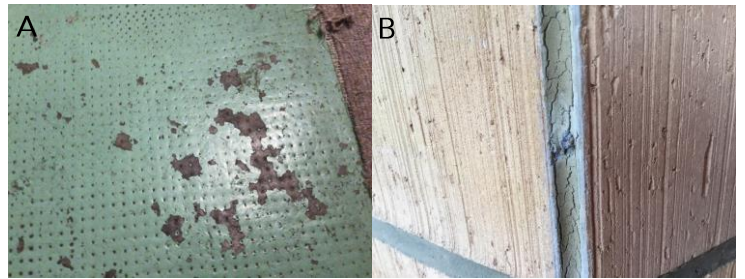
A – PCB-haltiger Kellerbodenanstrich. B – PCB-haltige Fugenmasse in der Ecke einer Backsteinmauer.
